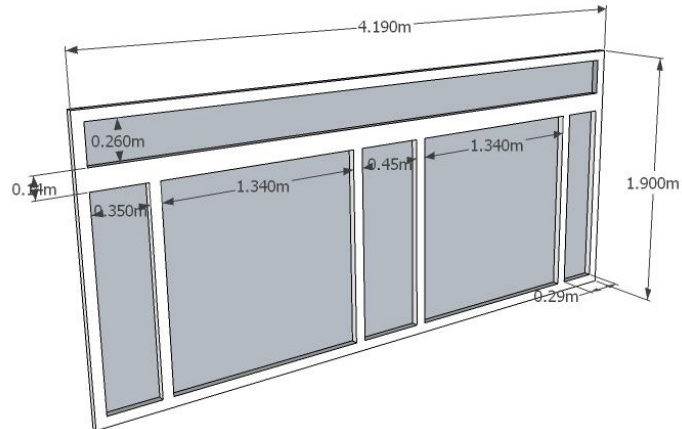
Ventana compuesta VC2. Primer piso, Fachada Norte.
